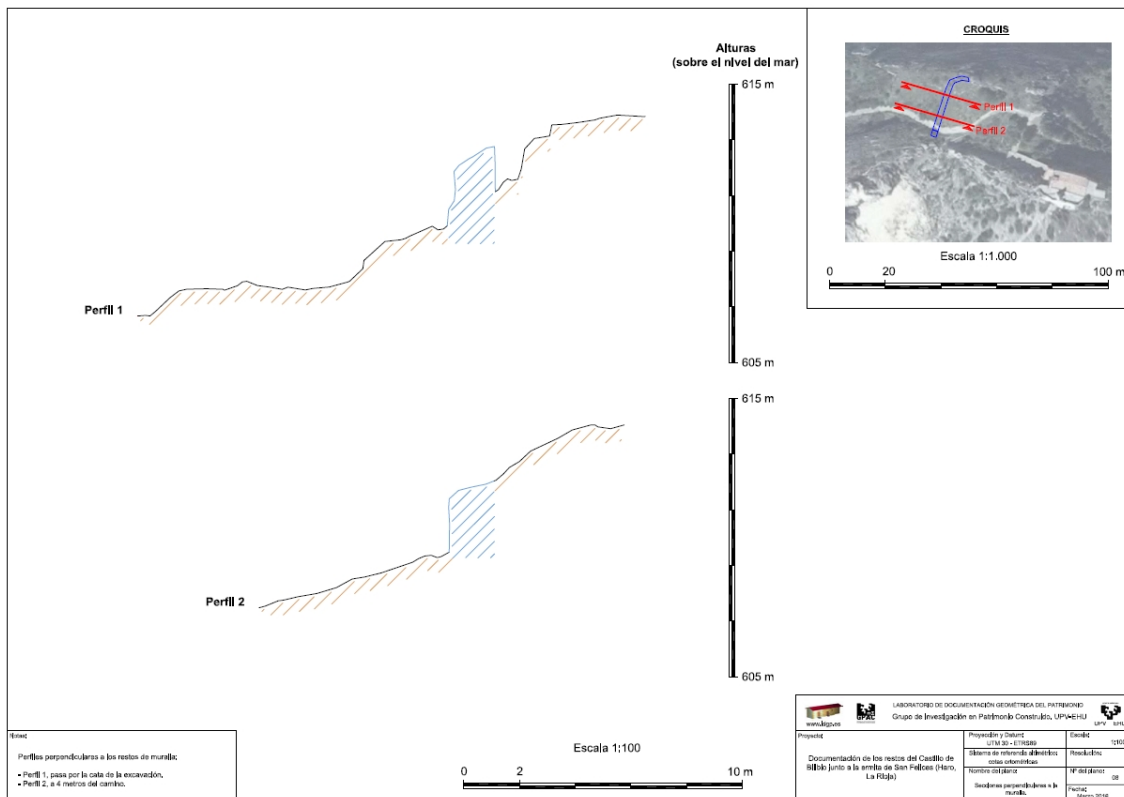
Plano de secciones perpendiculares a la muralla.
